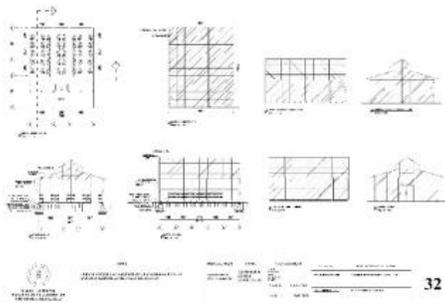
Denah, Tampak, Potongan, Rencana Atap, Utilitas, Listrik dan Pondasi
